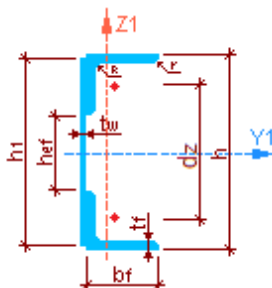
Схема профиля Швеллер сварной из листа и уголков
